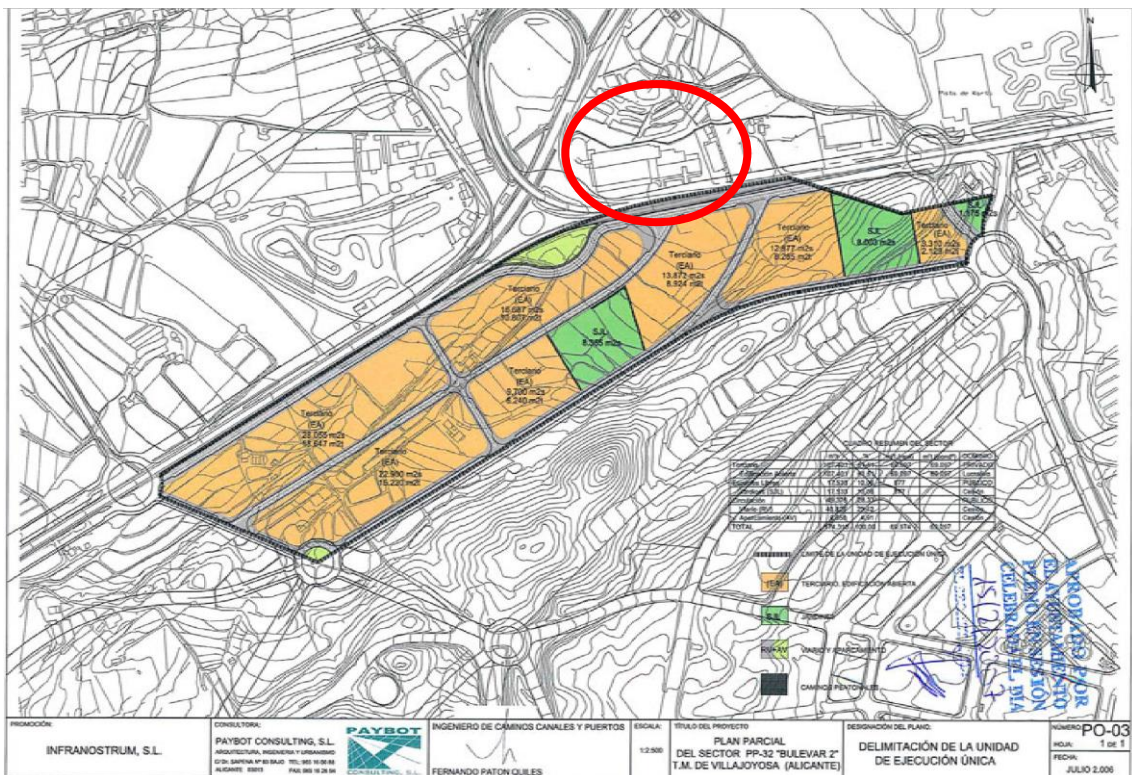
Plano de ordenación pormenorizada sector PP 32 (en rojo ámbito MP)
